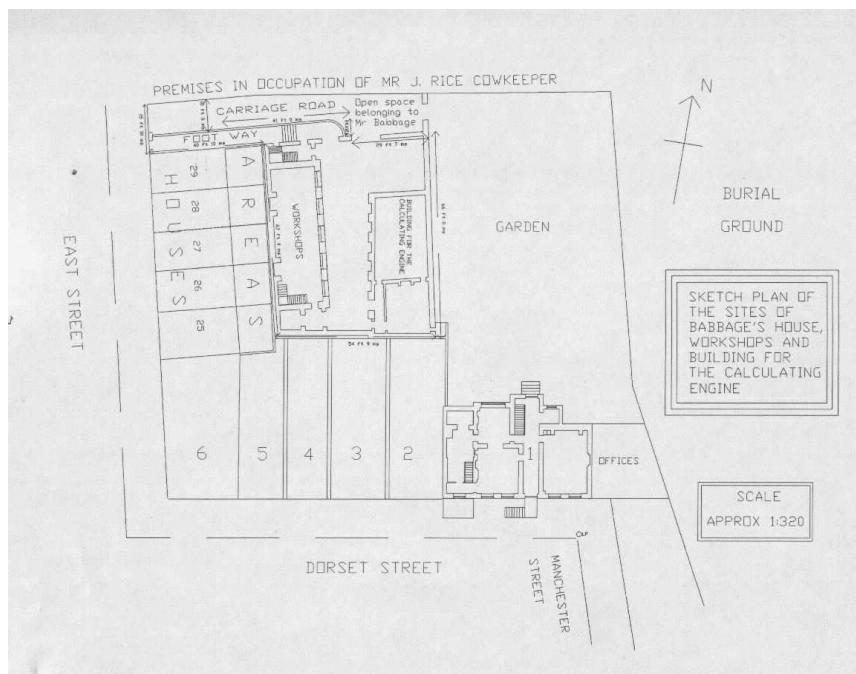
Der Grundriss des Hauses von Babbage mit den Werkstätten
